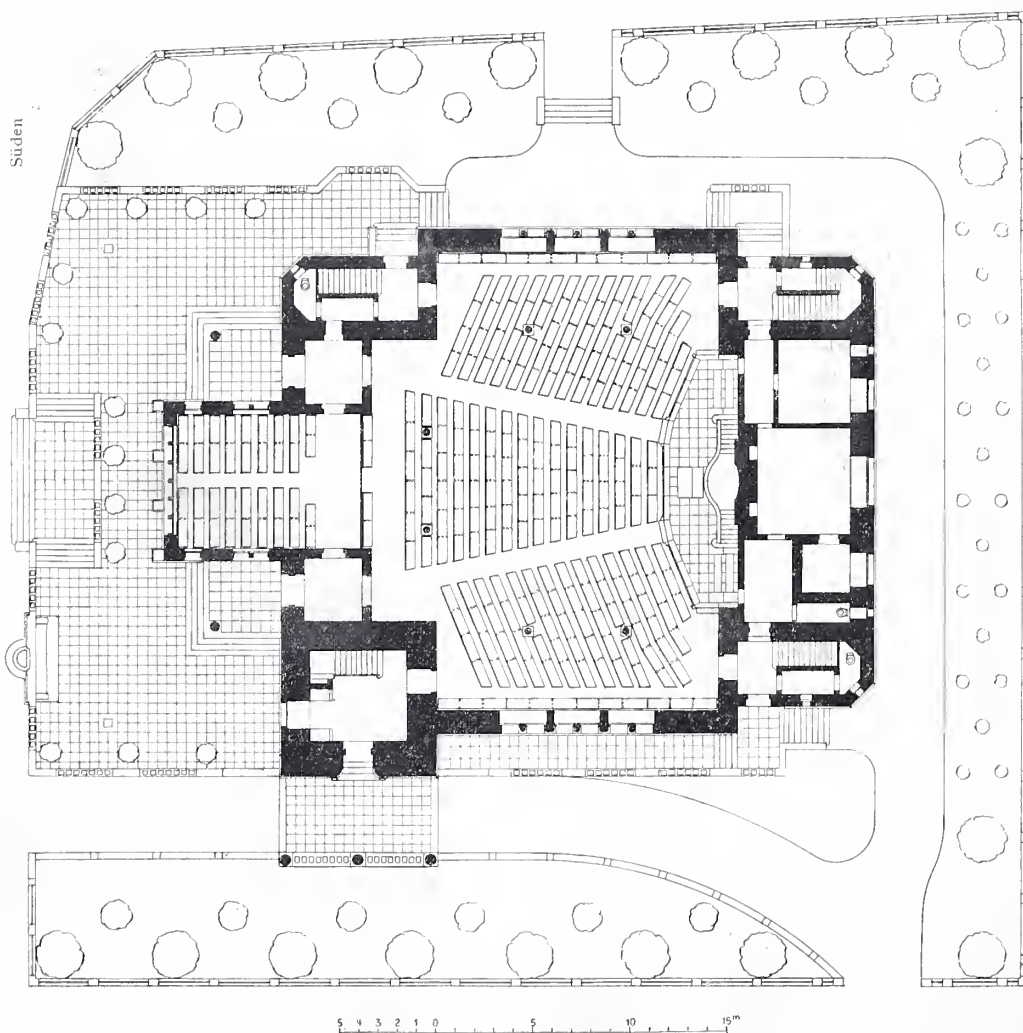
Grundriss vom Erdgeschoss. — Masstab 1 : 400.
